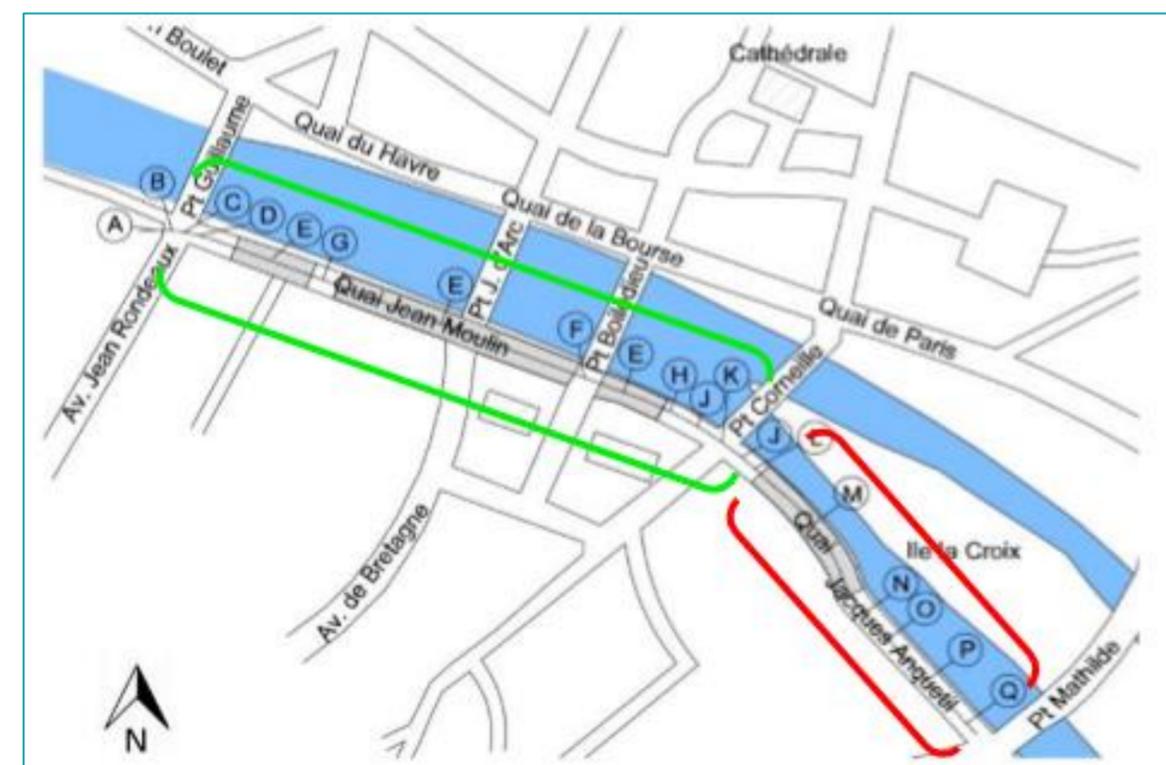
Schéma des ouvrages type de la tranchée couverte ferroviaire (en vert, section à conforter, en rouge section faisant l'objet d'une suppression)
